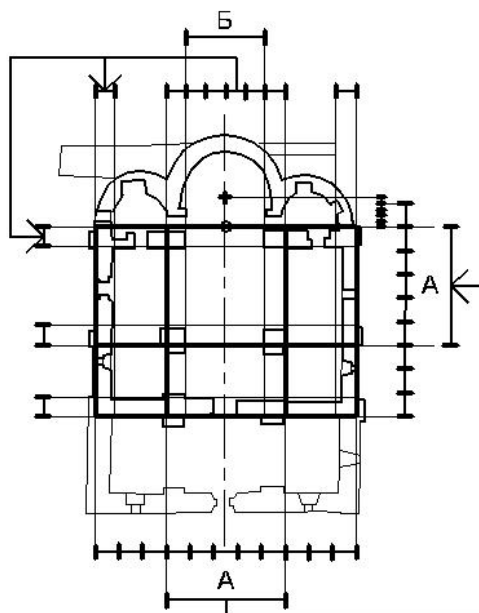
Разбивка плана на строительной площадке и определение дополнительных размеров.
